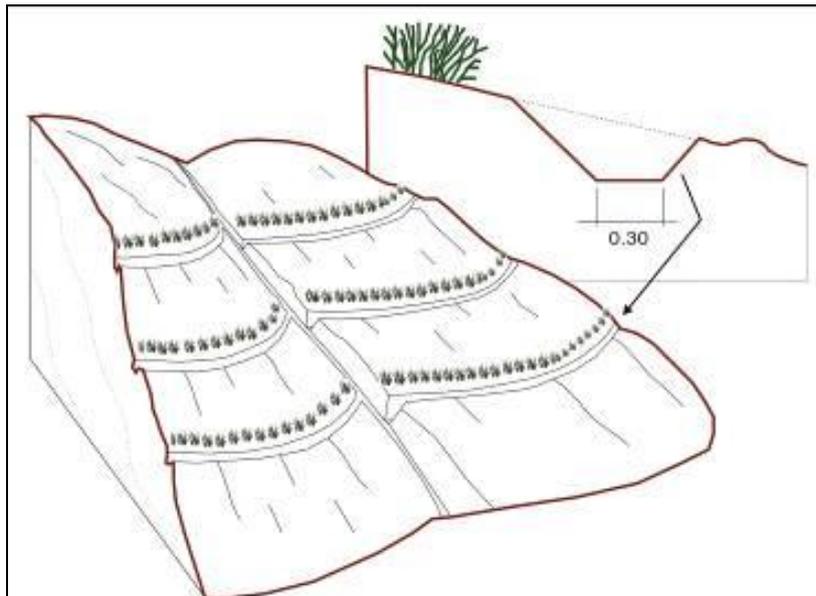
Sistema de drenaje en laderas ocupados por cultivos
